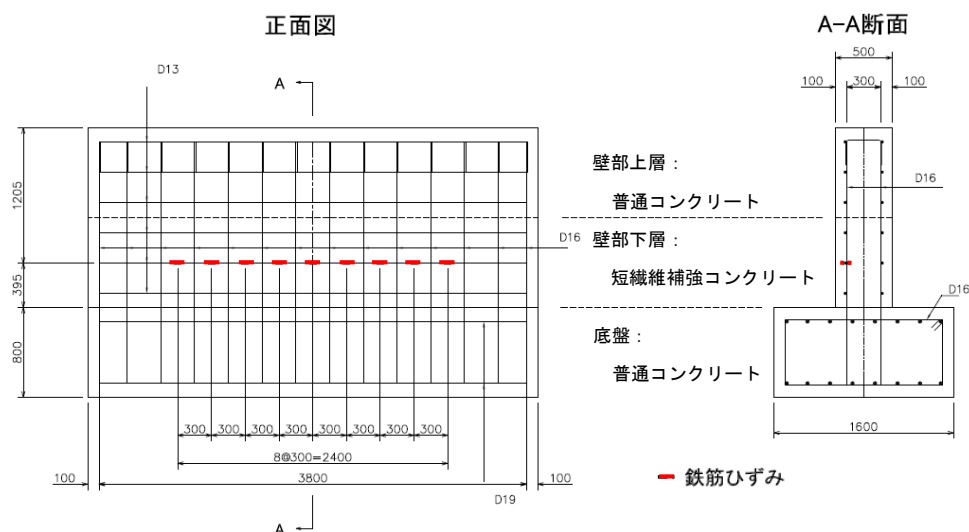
モデル試験体の形状寸法および鉄筋ゲージ位置
